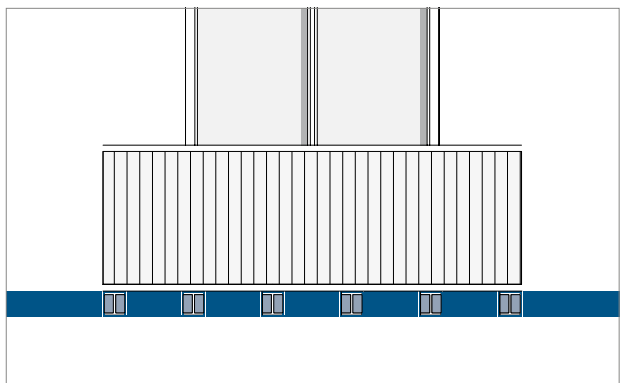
Schöck Isokorb® mit bauseitigen Brandschutzplatten im Brandriegel
